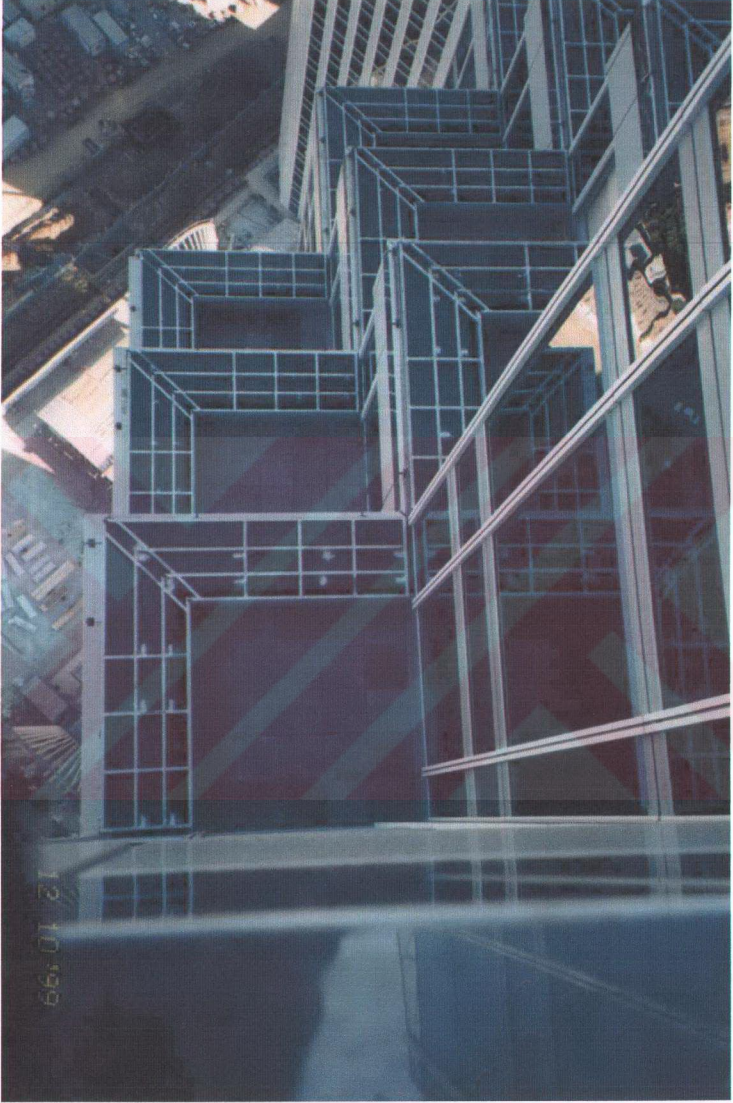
HOLZMANN HOCHHAUS Projesi plan detayı.
